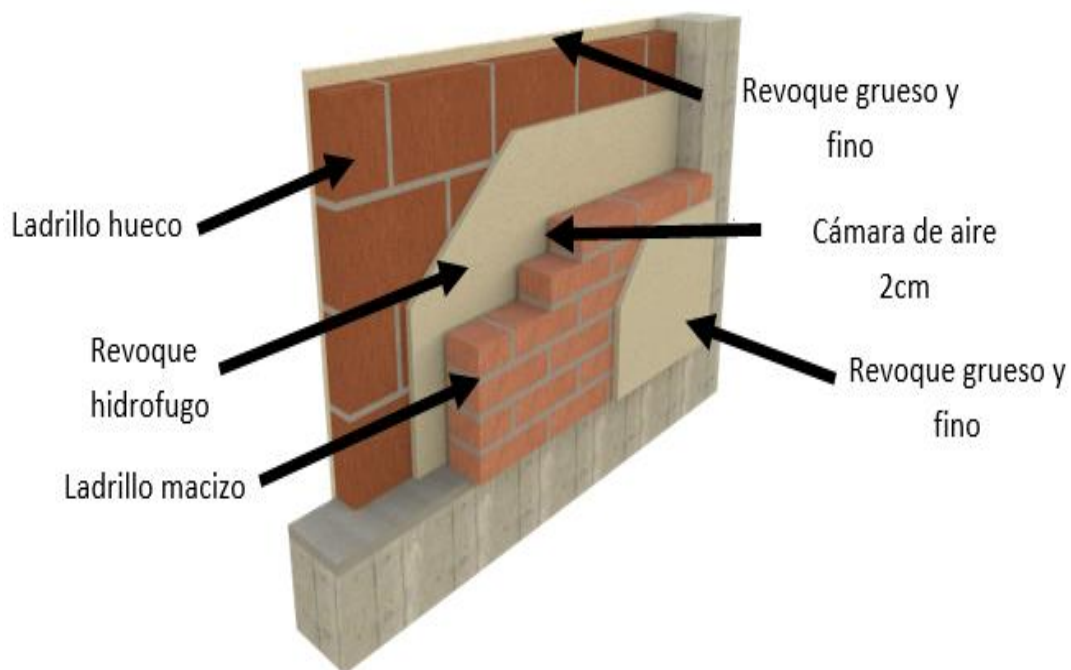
Detalle del muro doble Tipo E, doble y de construcción húmeda.
